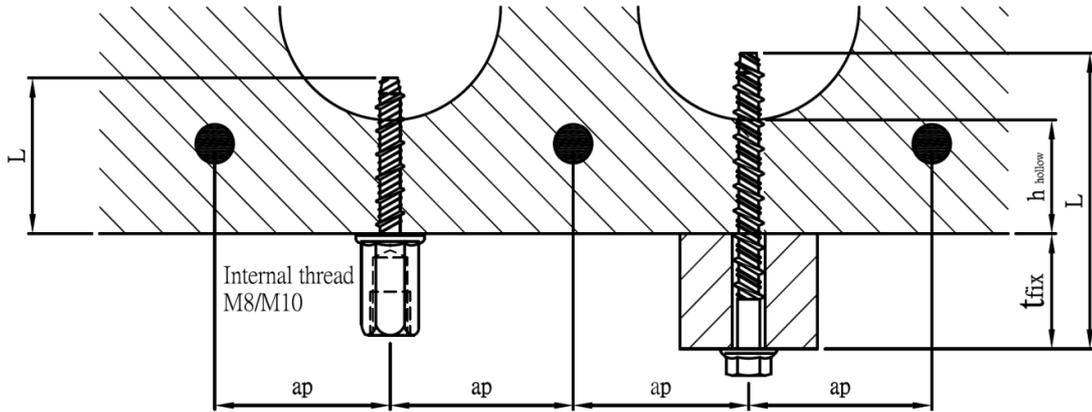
Condiciones de instalación para anclajes en losas alveolares de hormigón
